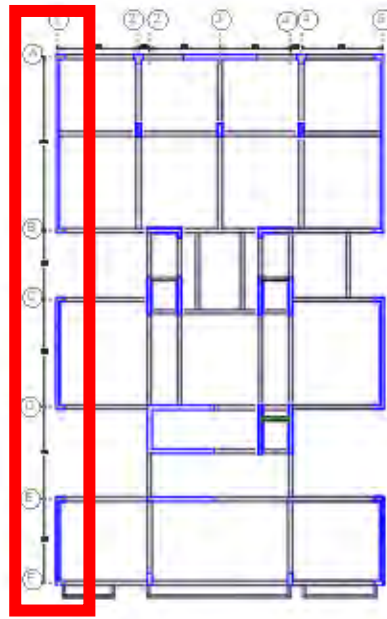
Vista en planta de las placas apoyadas en zapata Z-1
